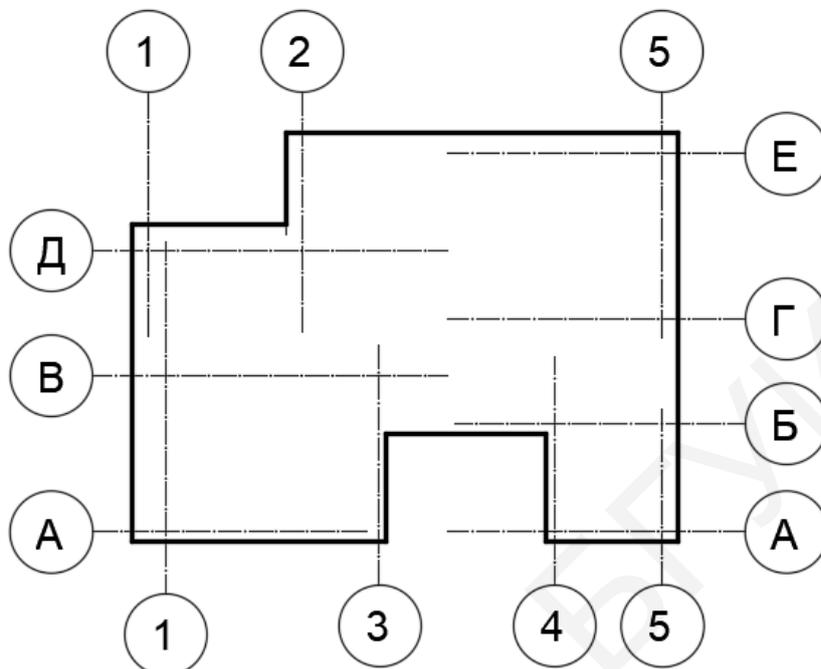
Разбивка плана здания координационными осями по всем фасадам здания
